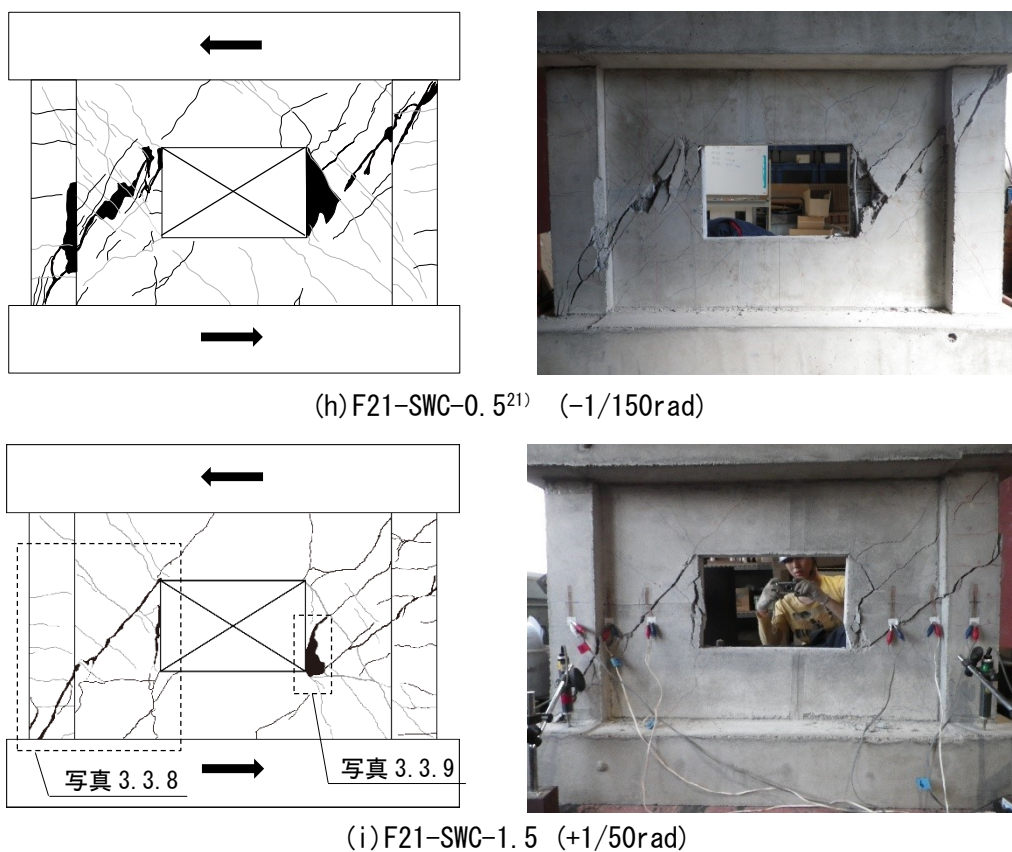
ひび割れ状況図 (→:実験終了時の加力方向) (続き)
